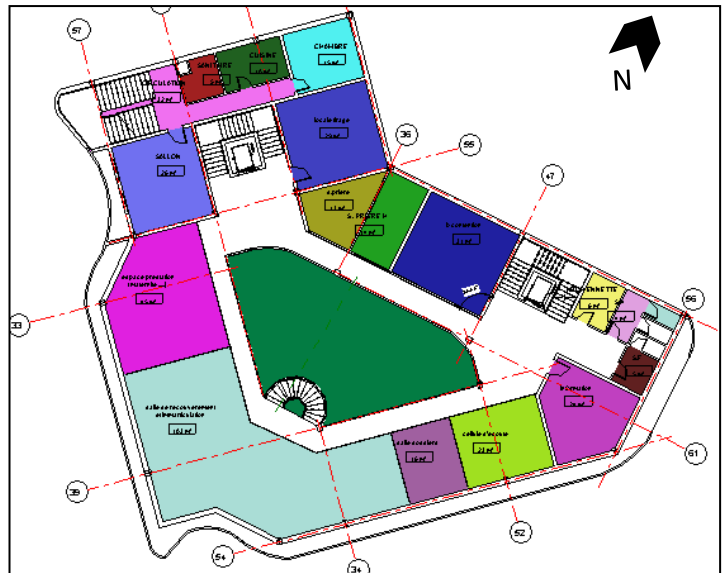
plan 1<sup>er</sup> étage Source : auteur
